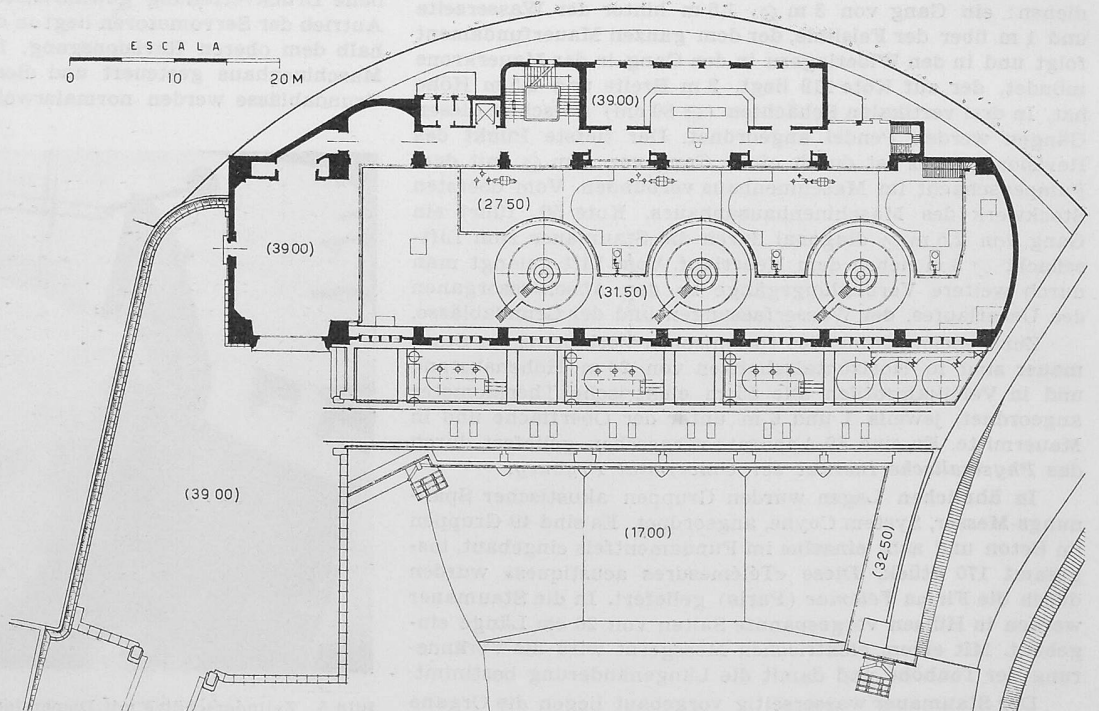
Grundriss des Maschinenhauses. Masstab rd. 1 : 700
